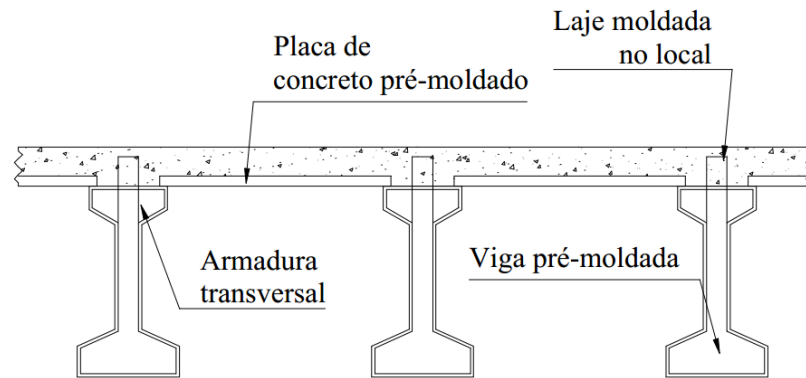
Exemplo de ponte executada com viga pré-moldada e laje moldada no local
